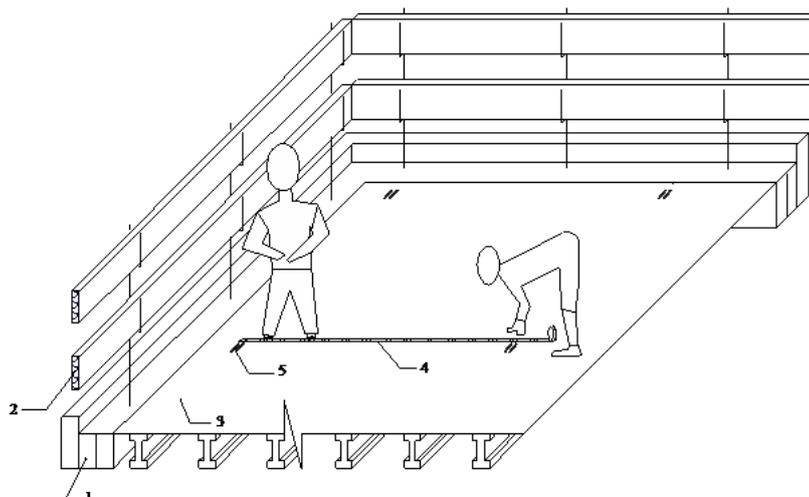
Разбивка палубы при устройстве нижней арматурной сетки: 1 – несущая стена; 2 инвентарное ограждение; 3 – палуба опалубки перекрытия; 4 рулетка; 5 вынесенные на палубу разбивочные оси
